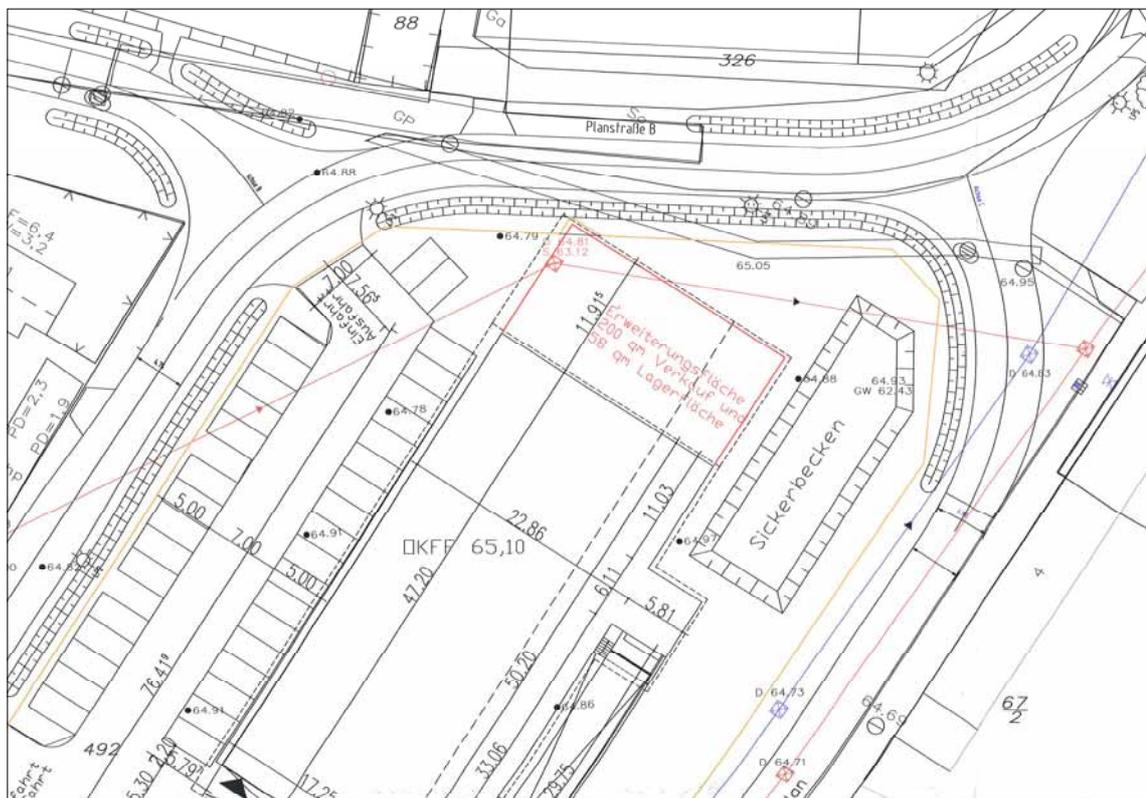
Objektlageplan Erweiterungsanbau Norma-Markt
